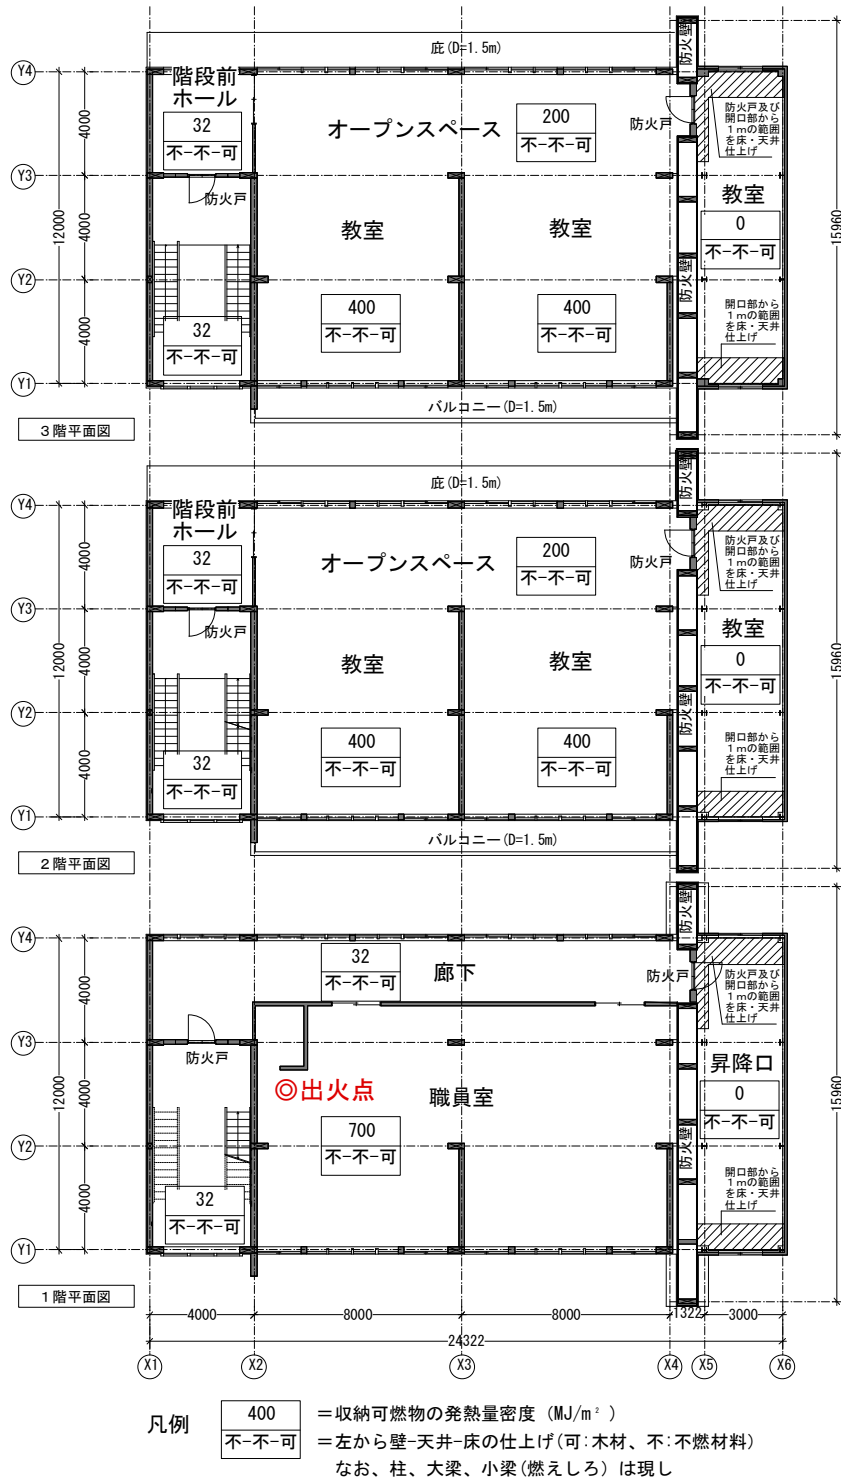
平面図および開口・収納可燃物等条件 (準備実験)
